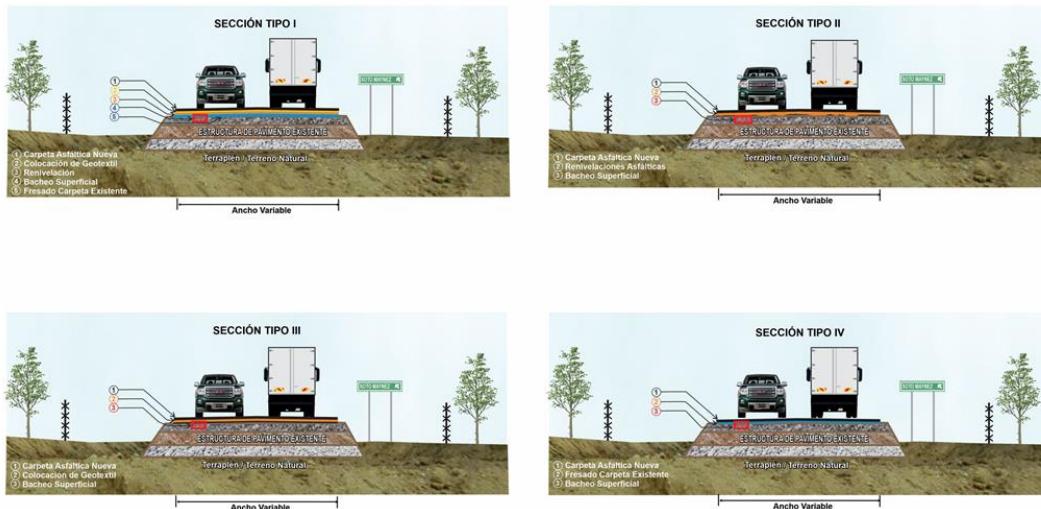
Sección Tipo de los trabajos de Reconstrucción (Fuente: Elaboración propia)
